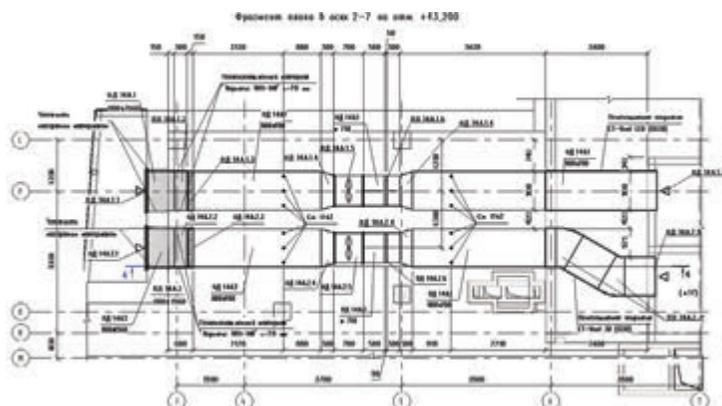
Фрагмент плана системы приточно-вытяжной вентиляции
